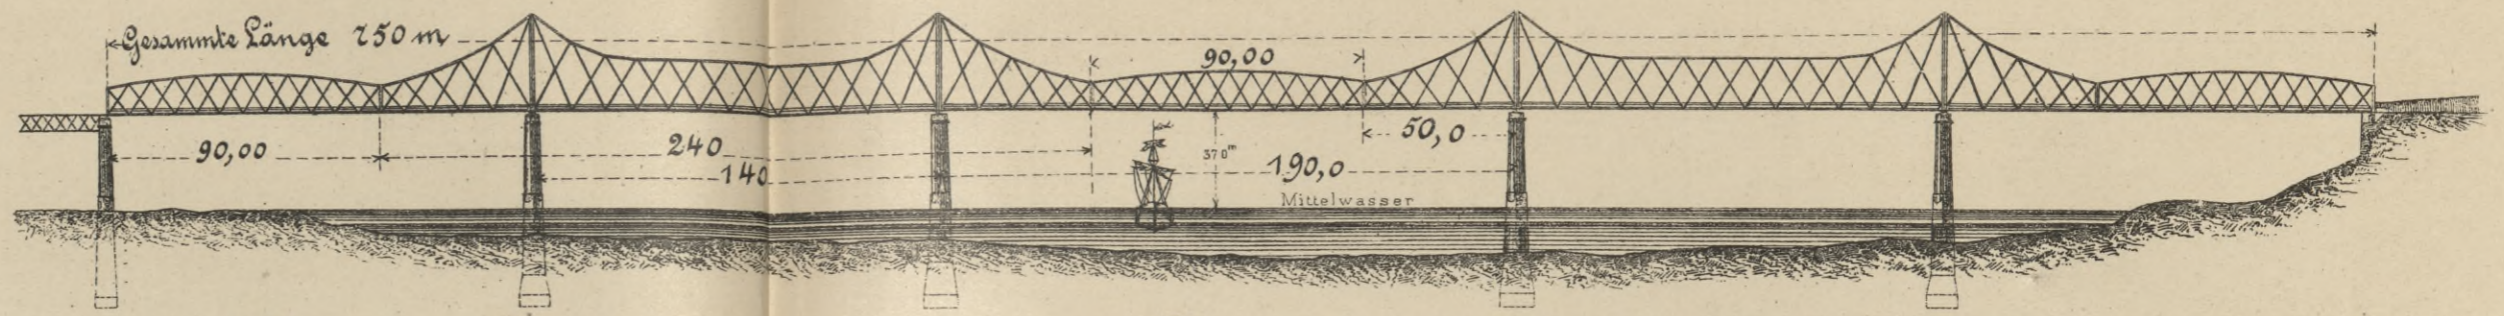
& 2. Ansicht und Grundriß der Donaubrücke bei Cernavoda. Maßstab 1:2500.
